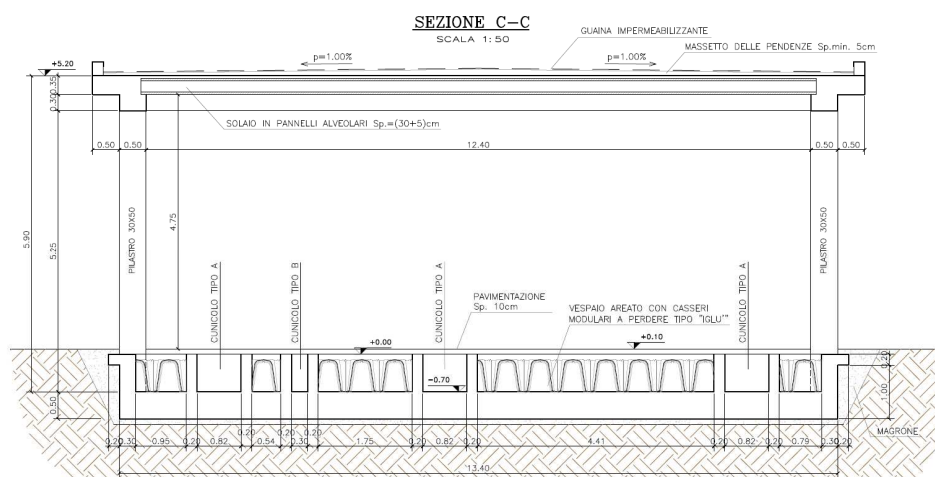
Sezione trasversale carpenteria Corpo 2 nuova sottostazione elettrica.
